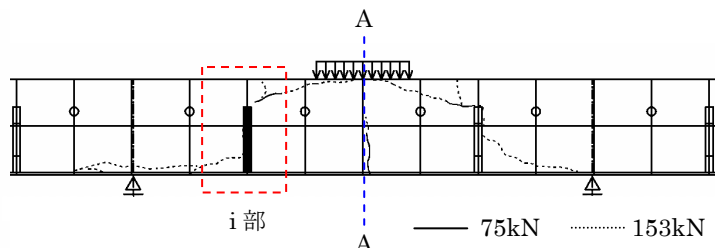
ひび割れ状況図 (NP-1, 荷重ケース C)
